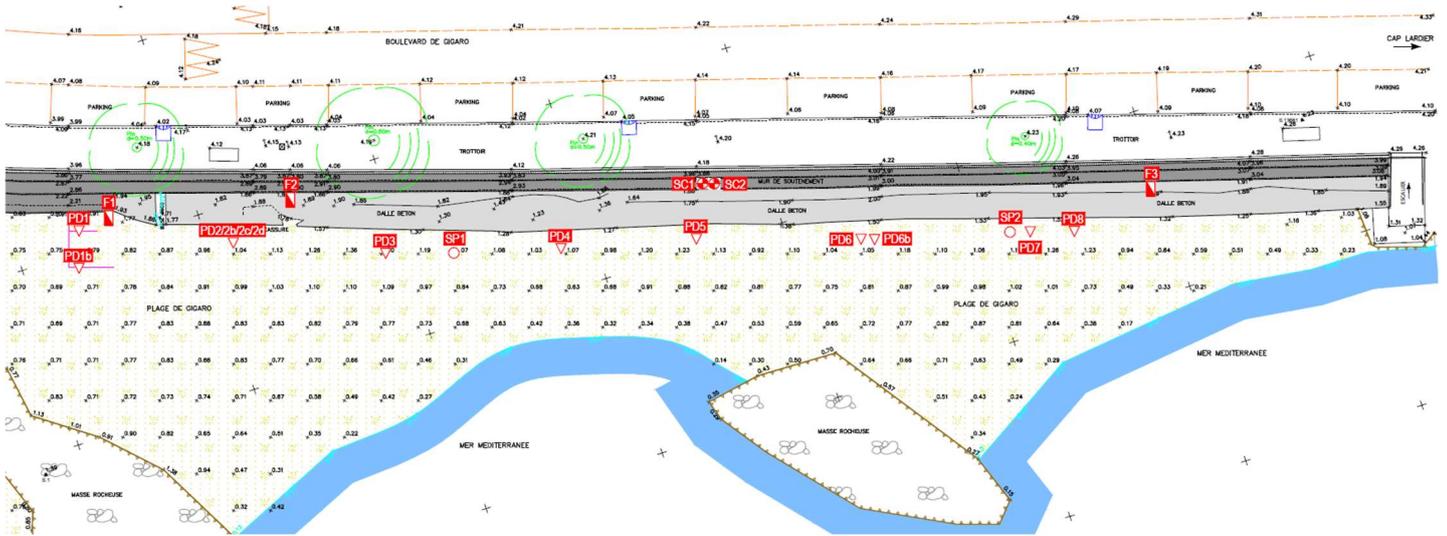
Plan implantation sondages @ ERG 2021/2022
